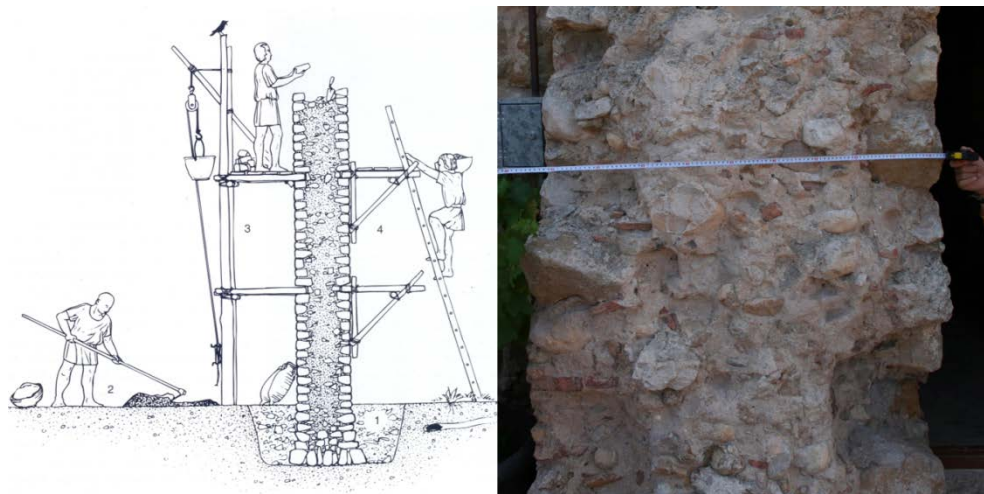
El hormigón de cal es un viejo material de construcción. Imagen de la izquierda, ilustración explicativa de la construcción de un muro romano [1]. Imagen de la derecha, contrafuerte roto de una masía en l'Empordà (Girona). Fotografía JRRA.
